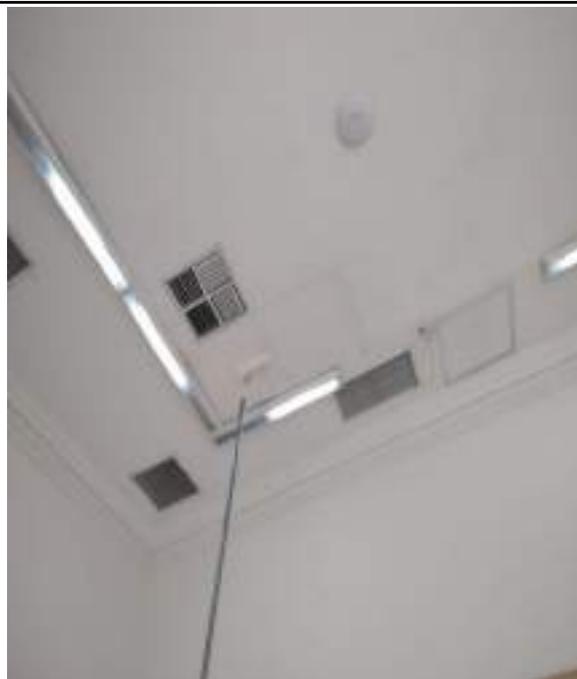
Conservação civil forro das salas do primeiro pavimento.
